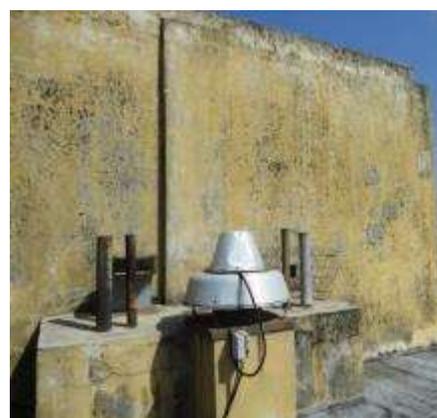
Fachada norte. Pintura desconchada. Caso estudio 5. Fuente FF
